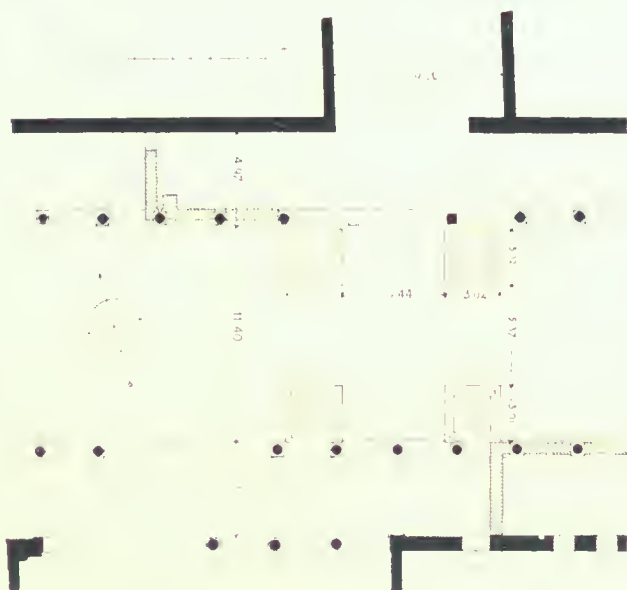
Grundriss der Arkadiane bei der Straßenkreuzung
